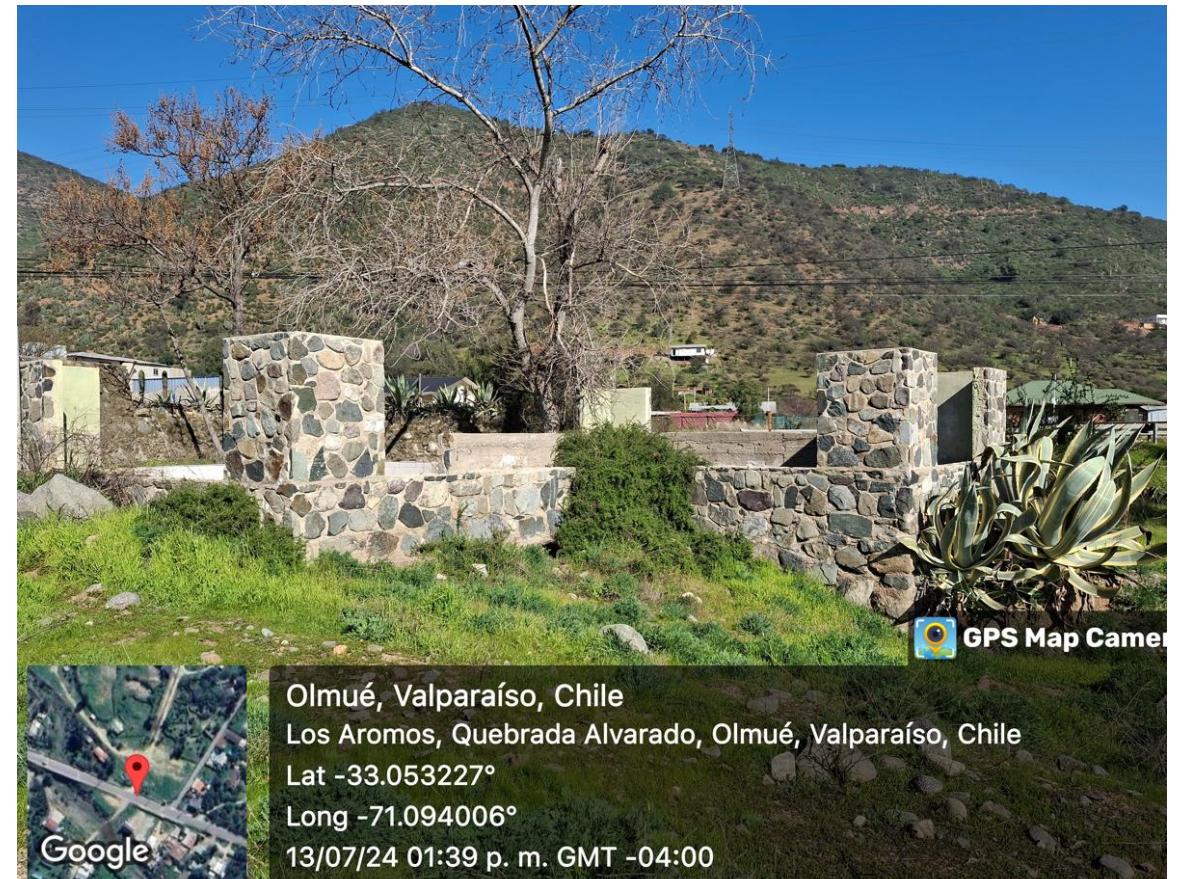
SECTOR TIENDAS DE CAMPING
